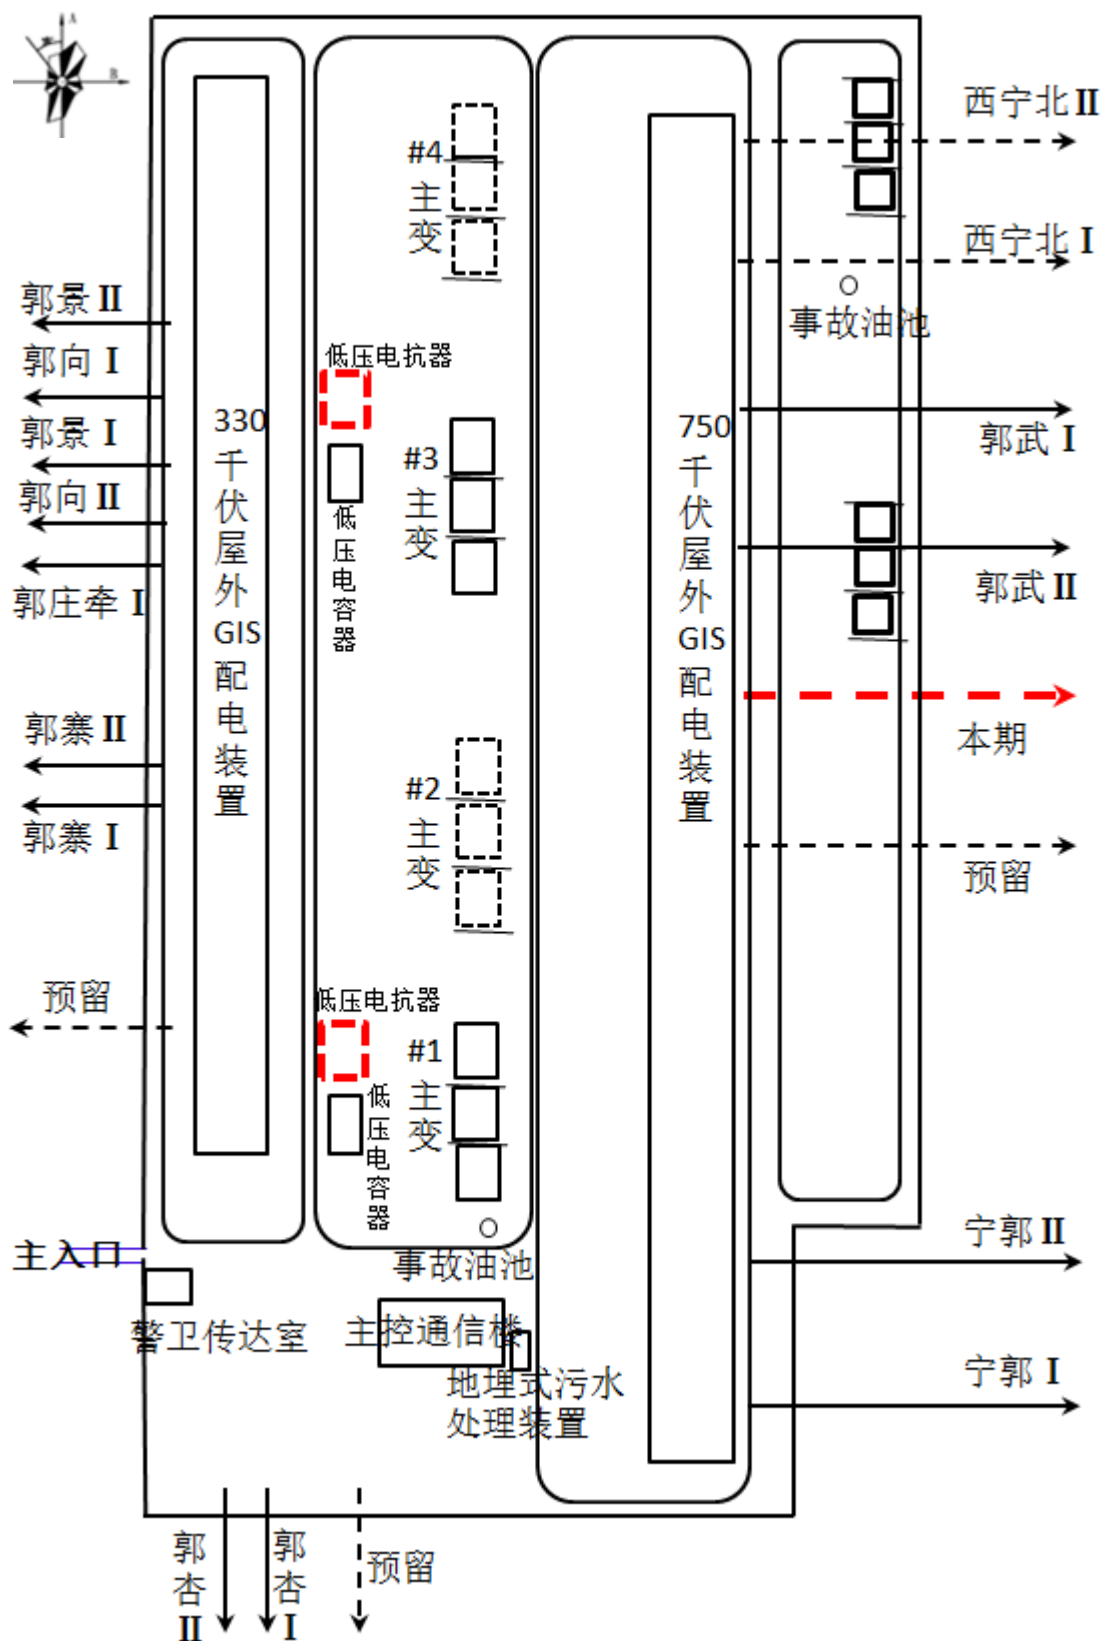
郭隆 750kV 变电站总平面布置示意图
